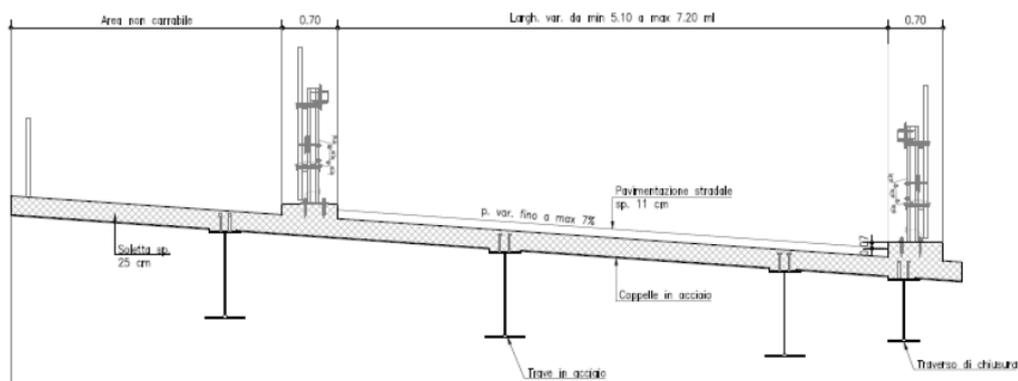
Sezione tipo Impalcato 1 (Fonte: Lista di controllo)
